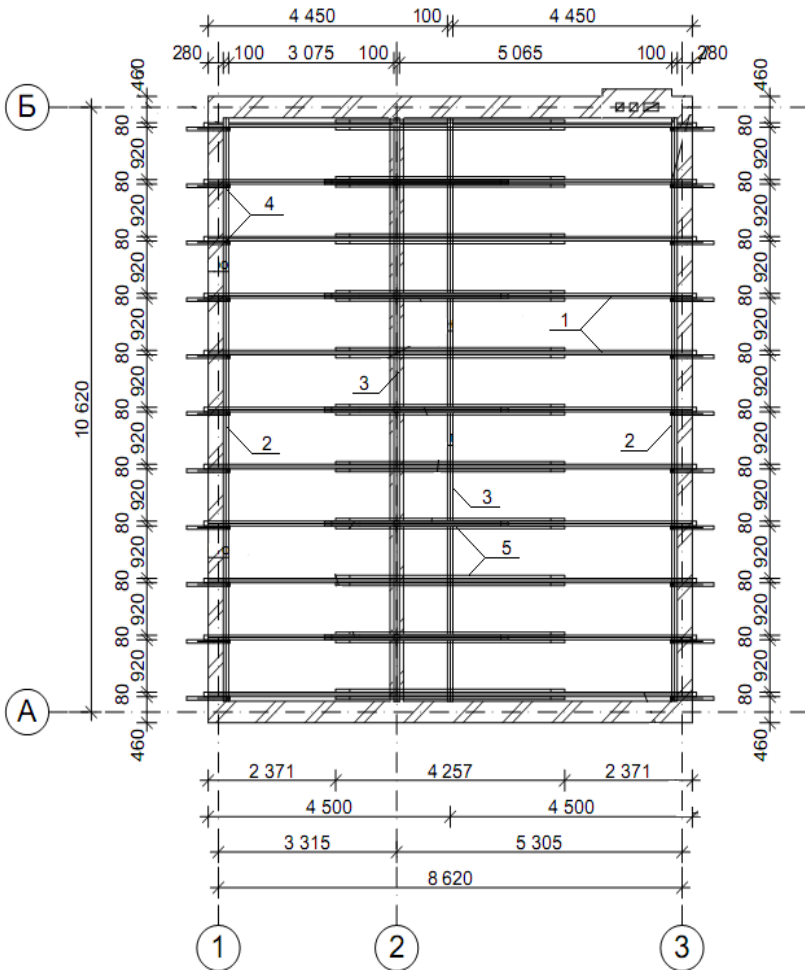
Пример оформления схемы расположения стропил малоэтажного жилого дома
